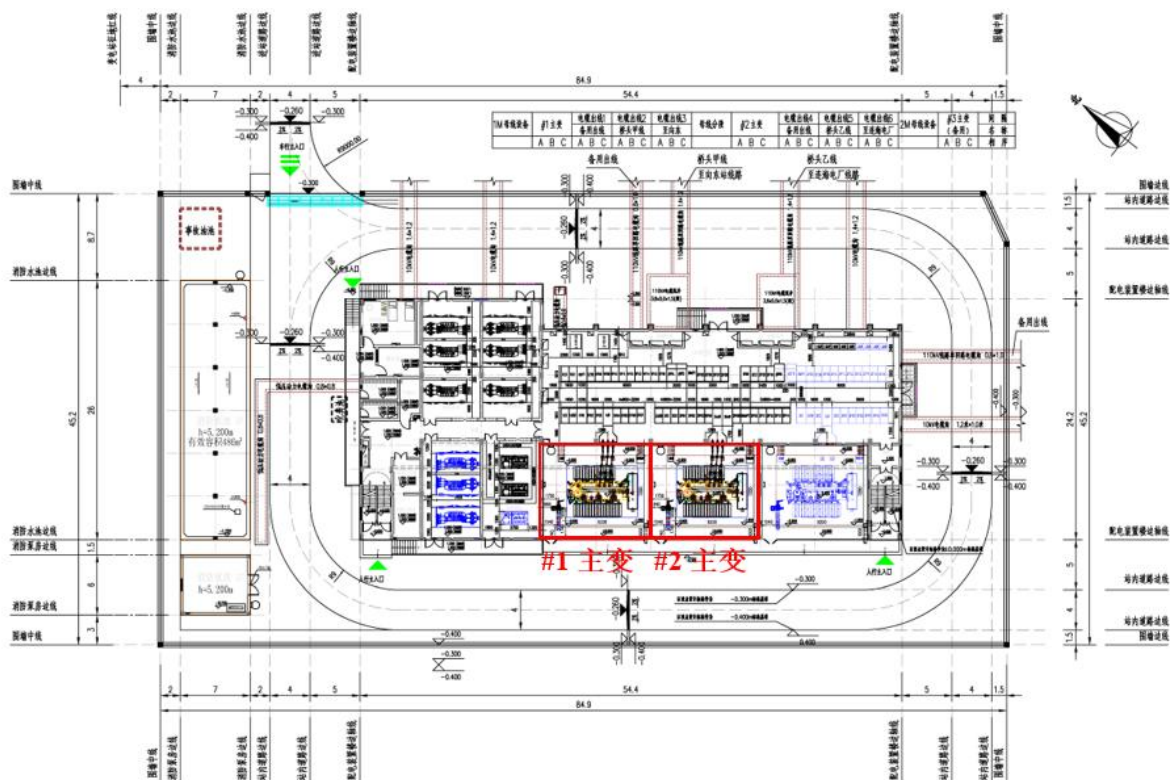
本项目 110 千伏金瓯变电站总平面布置图
